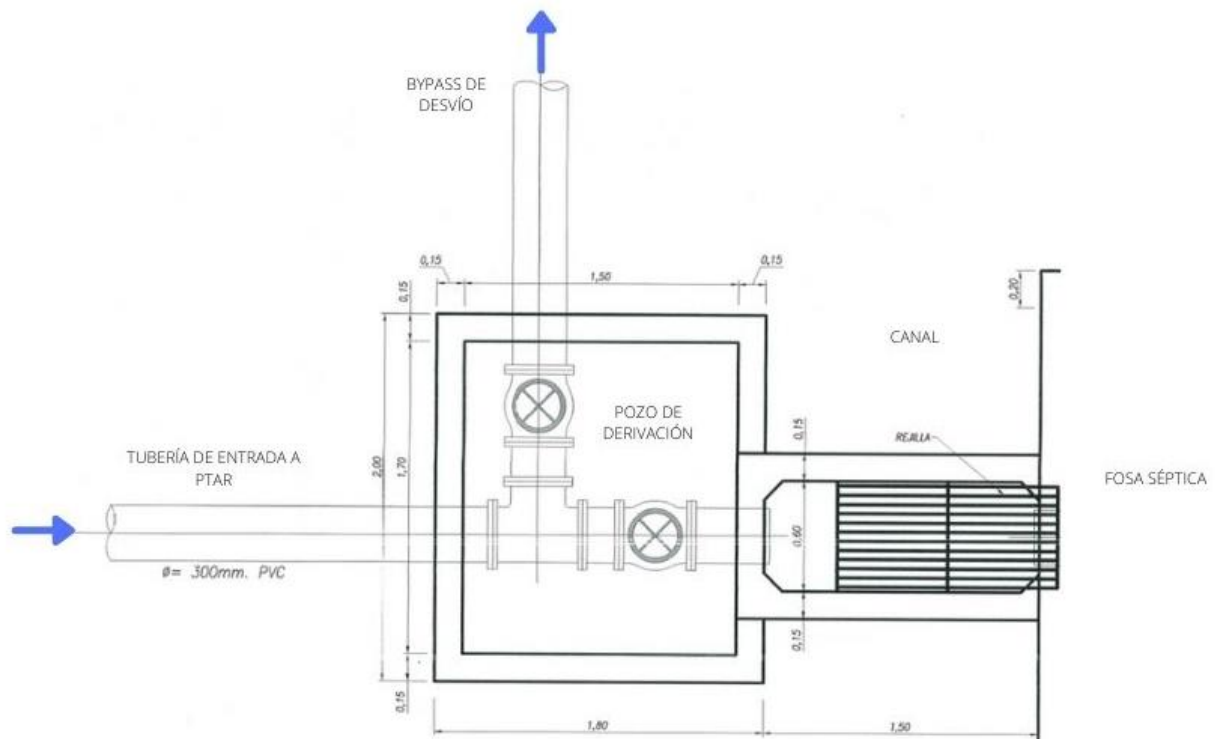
Vista en planta del pozo de revisión y canal de ingreso con rejillas
